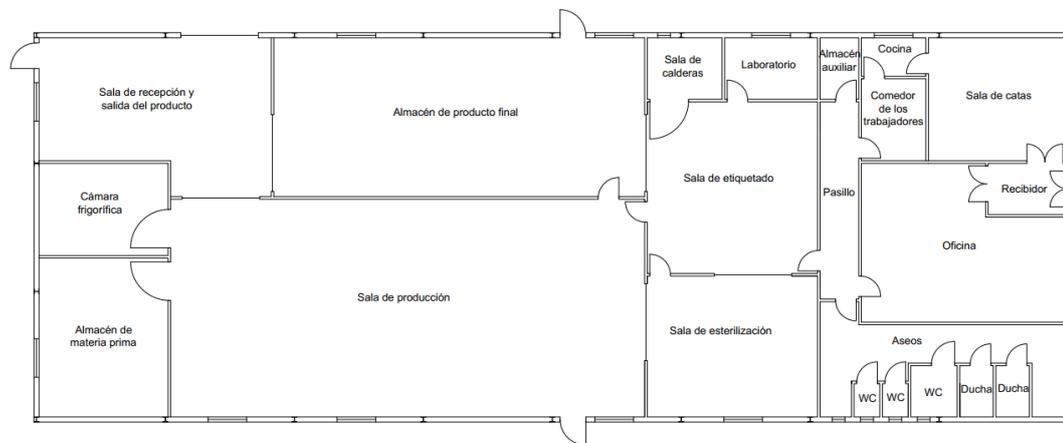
Planta del edificio. Fuente: elaboración propia.
